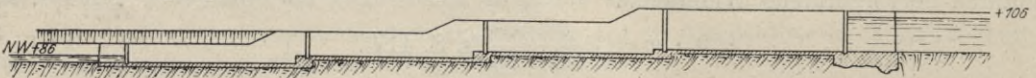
Schleusentreppe an der Staumauer von Assuan. Vier Schleusen mit je 6 m Gefälle.
